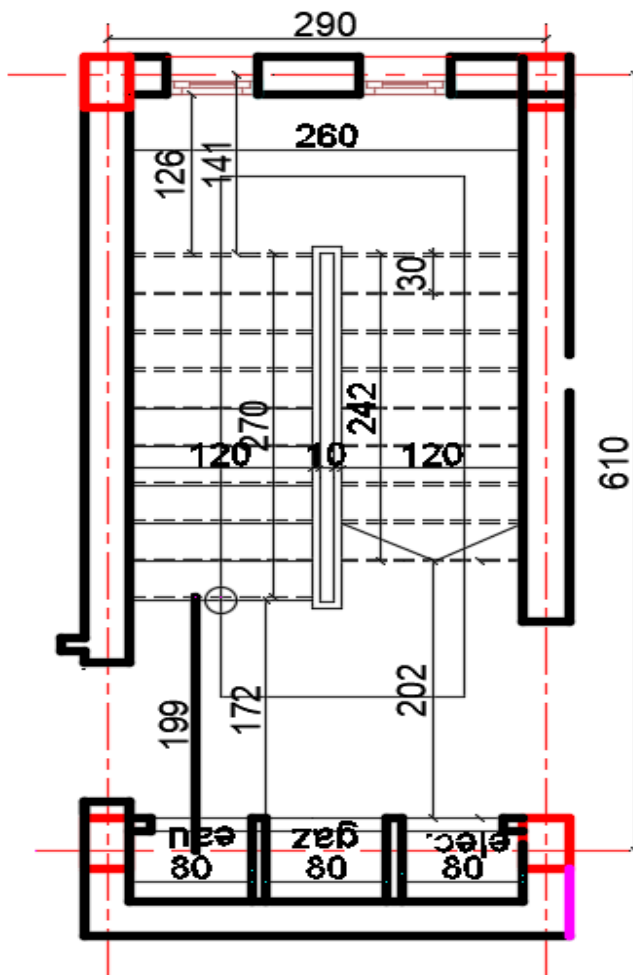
Vue en plan de la cage d'escalier type n°1
